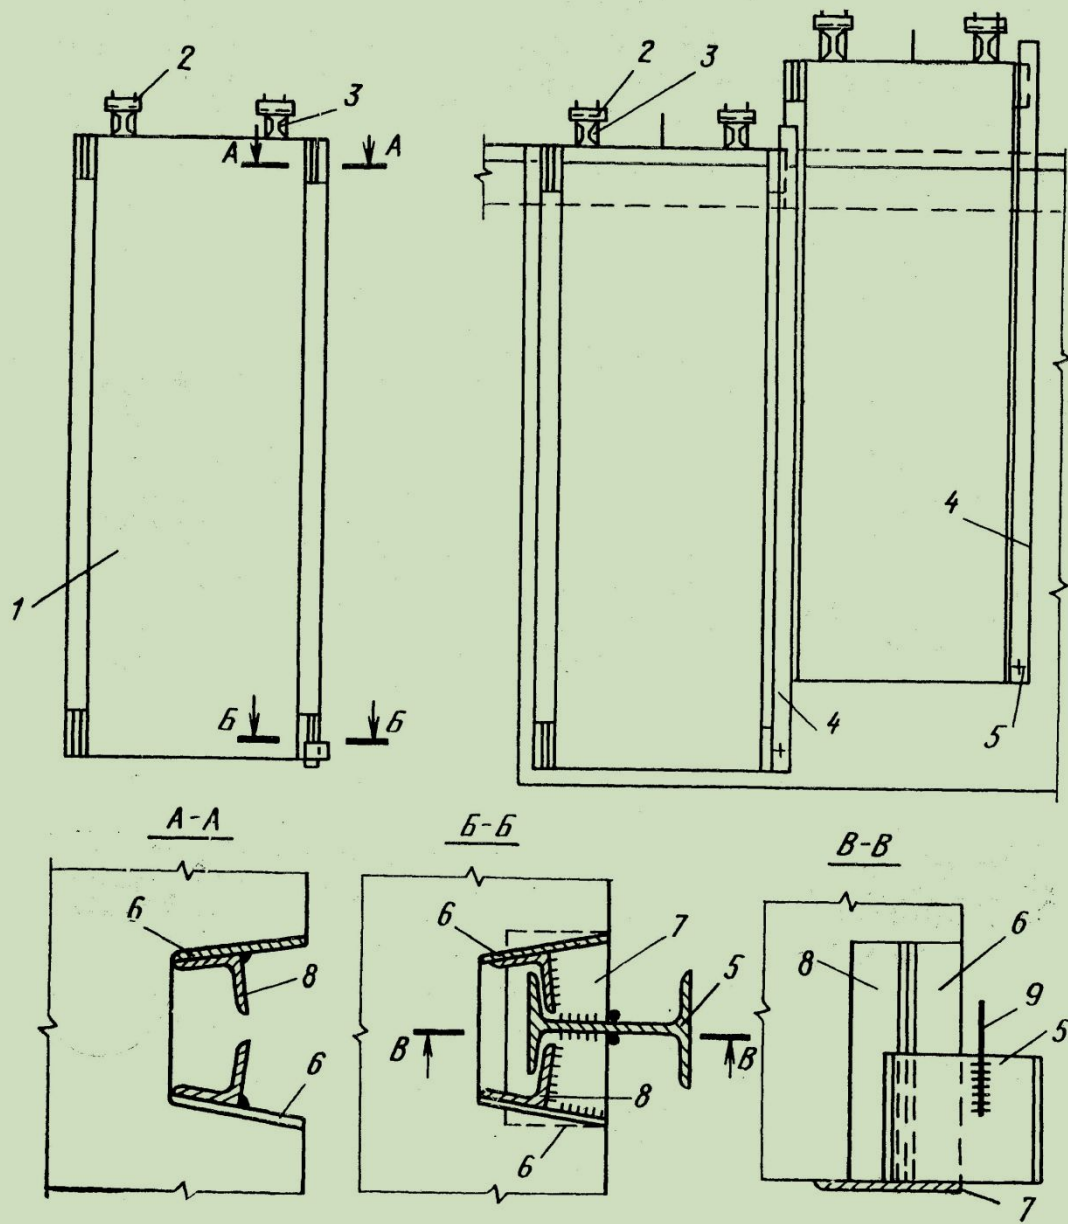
Сборные стены в грунте конструкции треста Гидроспец-
